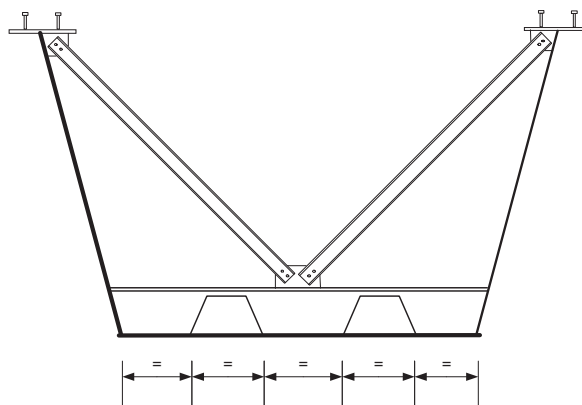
Poutre-caisson à raidisseurs trapézoïdaux sur la semelle inférieure.
